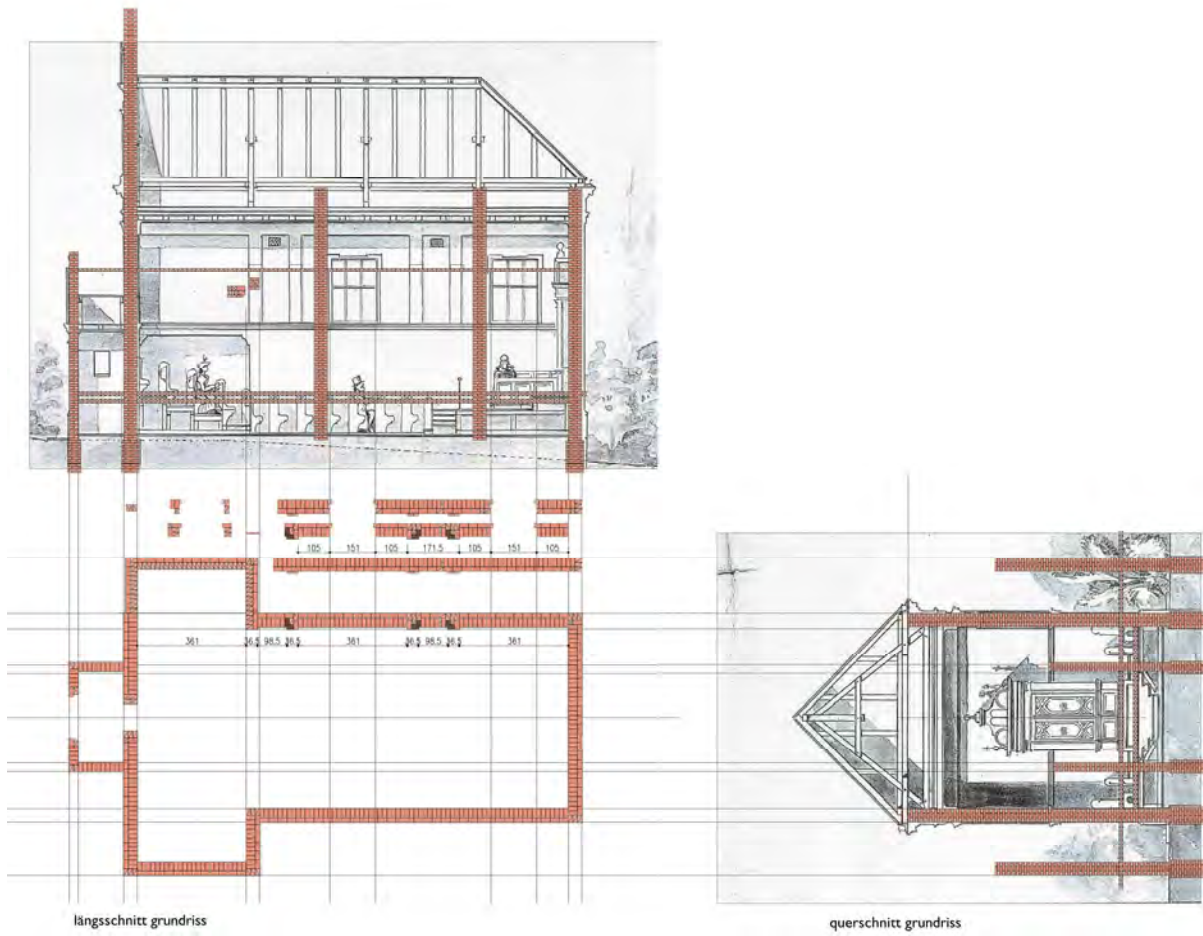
Grundriss aus Querschnitt- Längsschnittdarstellungen
